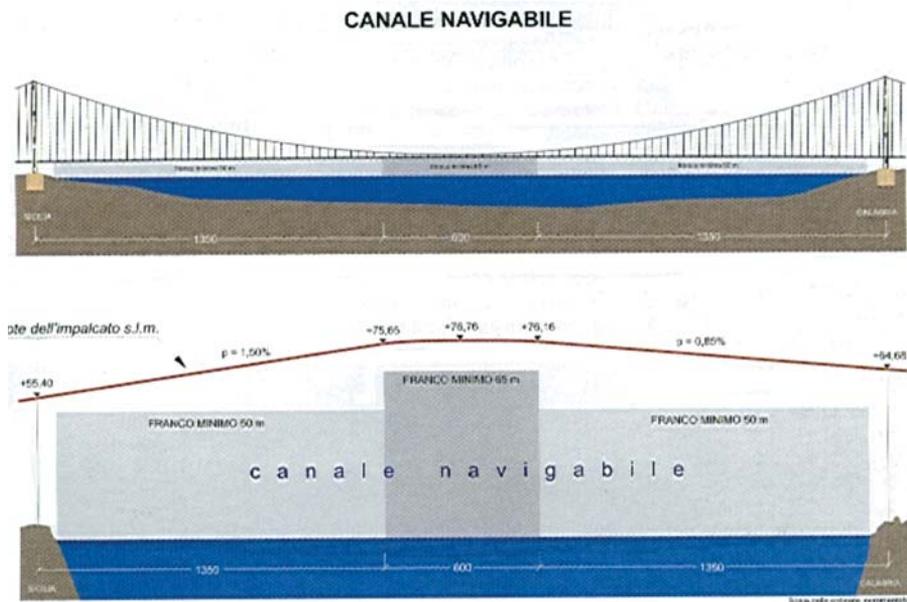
Sezione del Ponte della Stretto di Messina SpA
